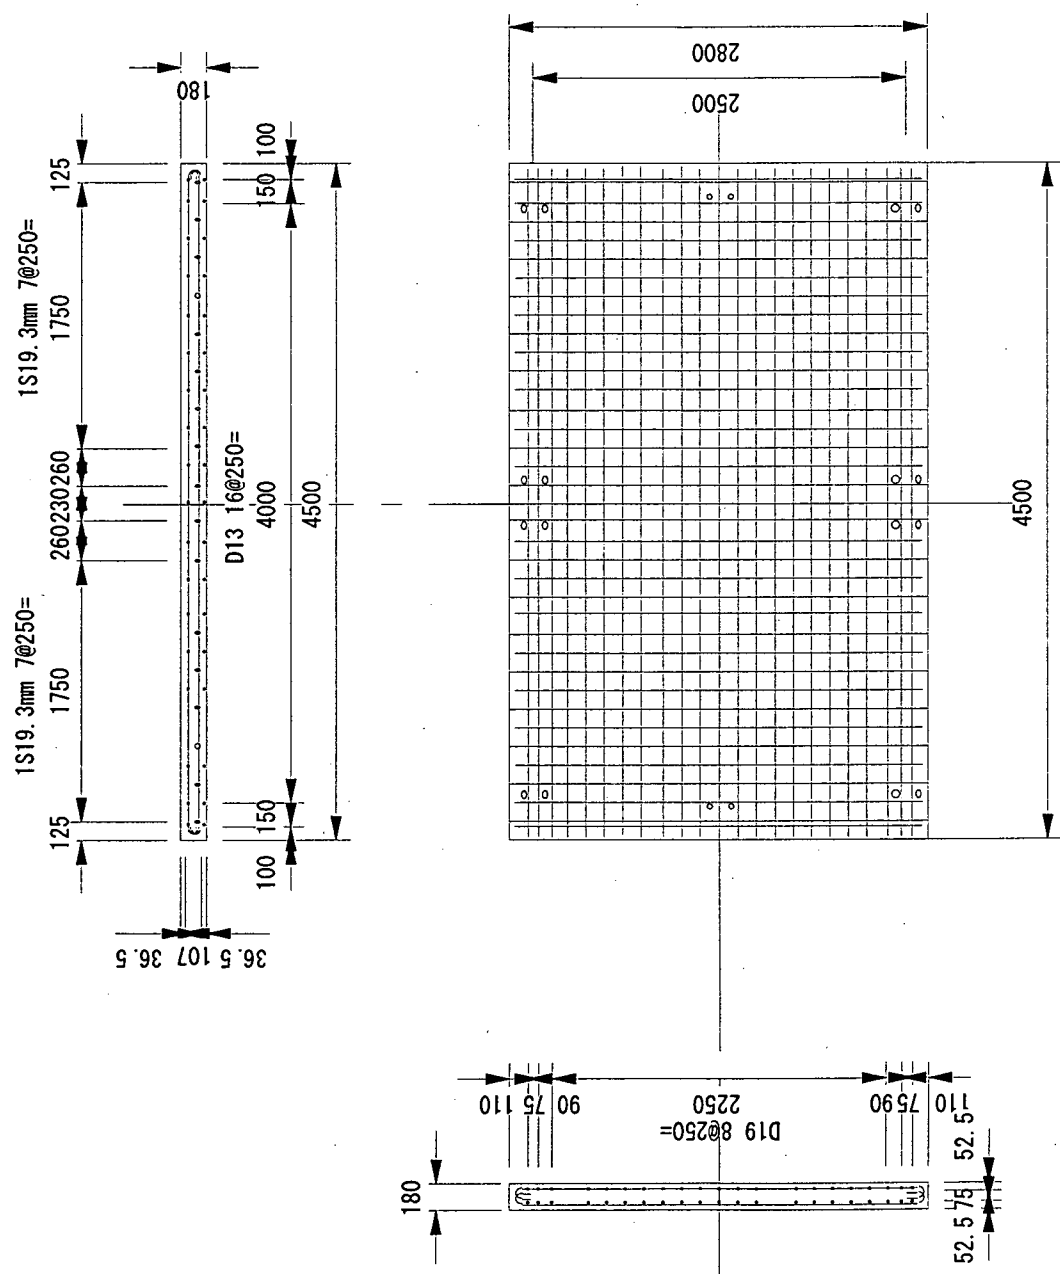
PC8供試体の形状・寸法 (単位:mm)
